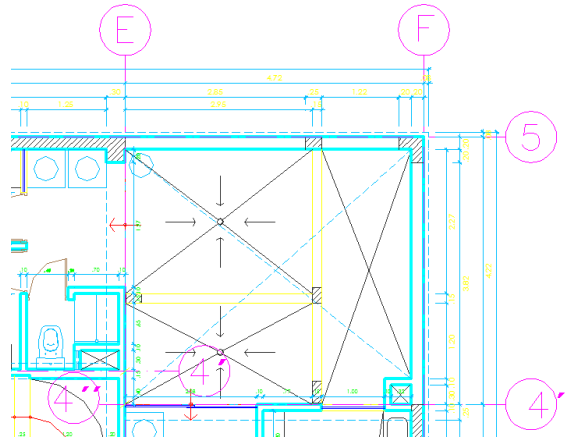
Planta del Primer Nivel – “Cotas”
